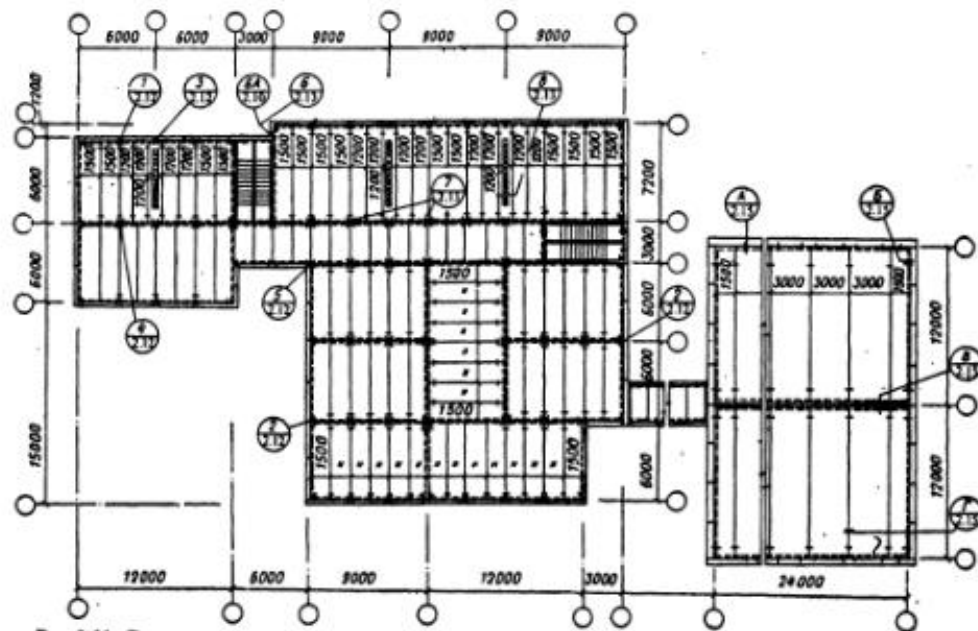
Схема монтажного плана панелей перекрытия, покрытия (залов) с маркировкой узлов
